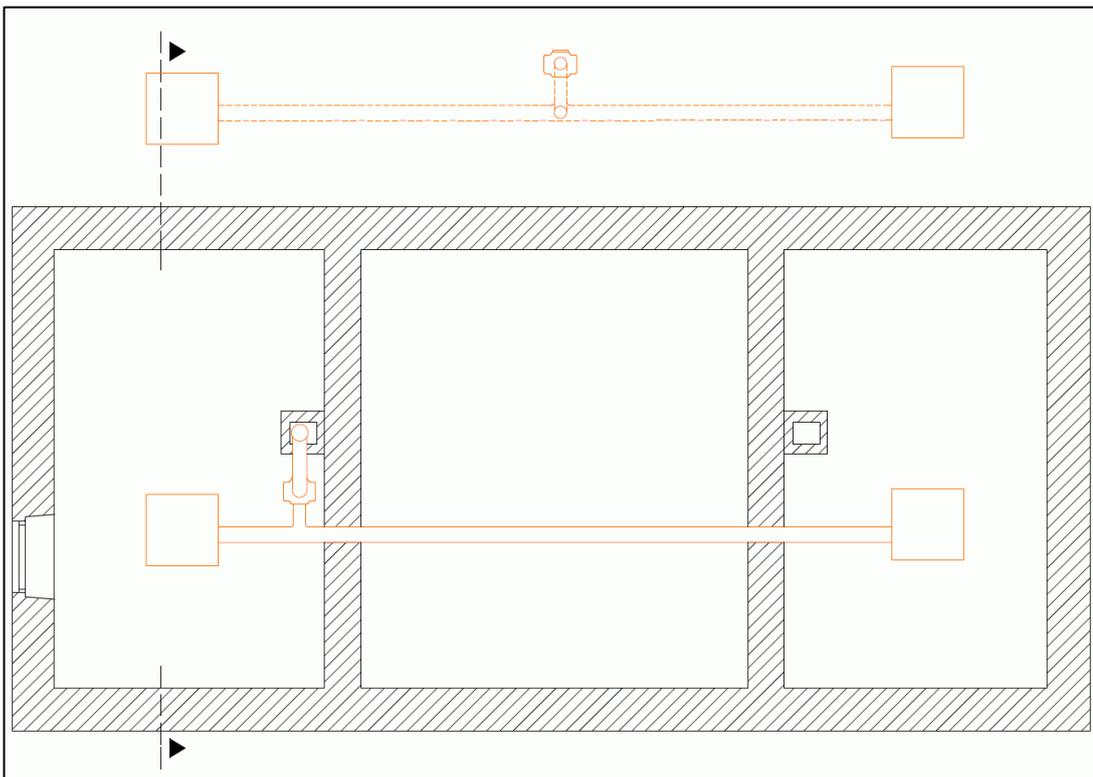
Anordnung Radonbrunnen, Grundriss
